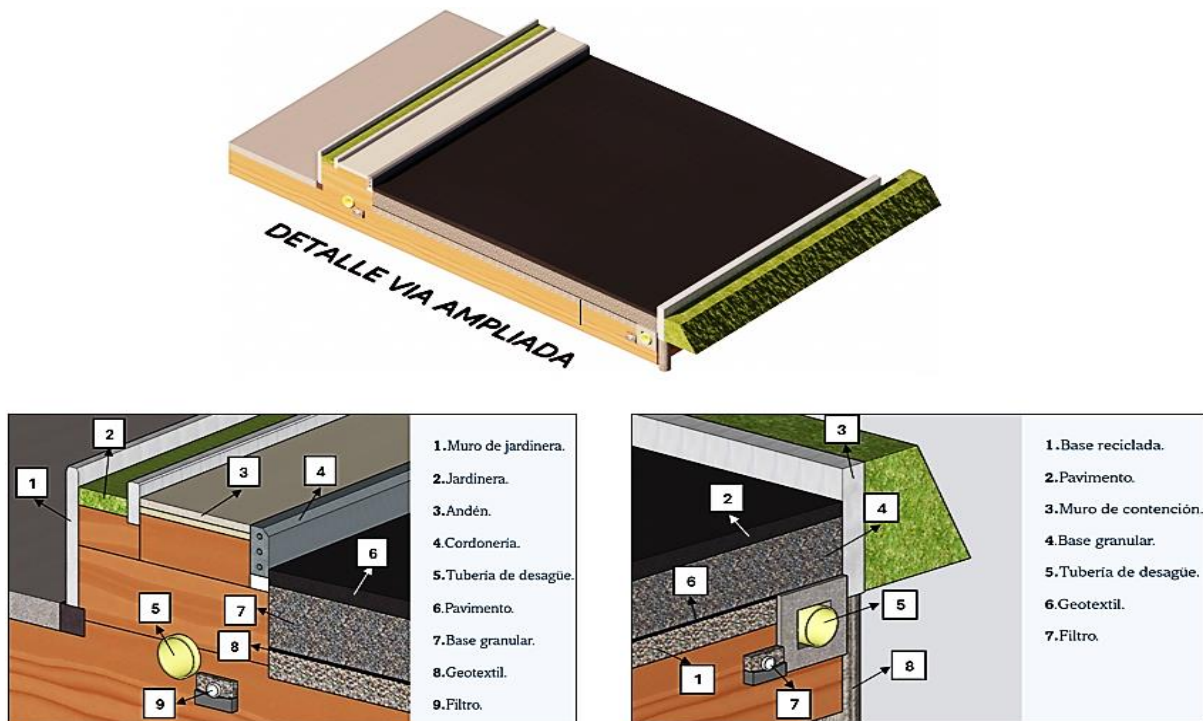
Detalles constructivos y elementos de vía (sección 2). Fuente: elaboración propia.
